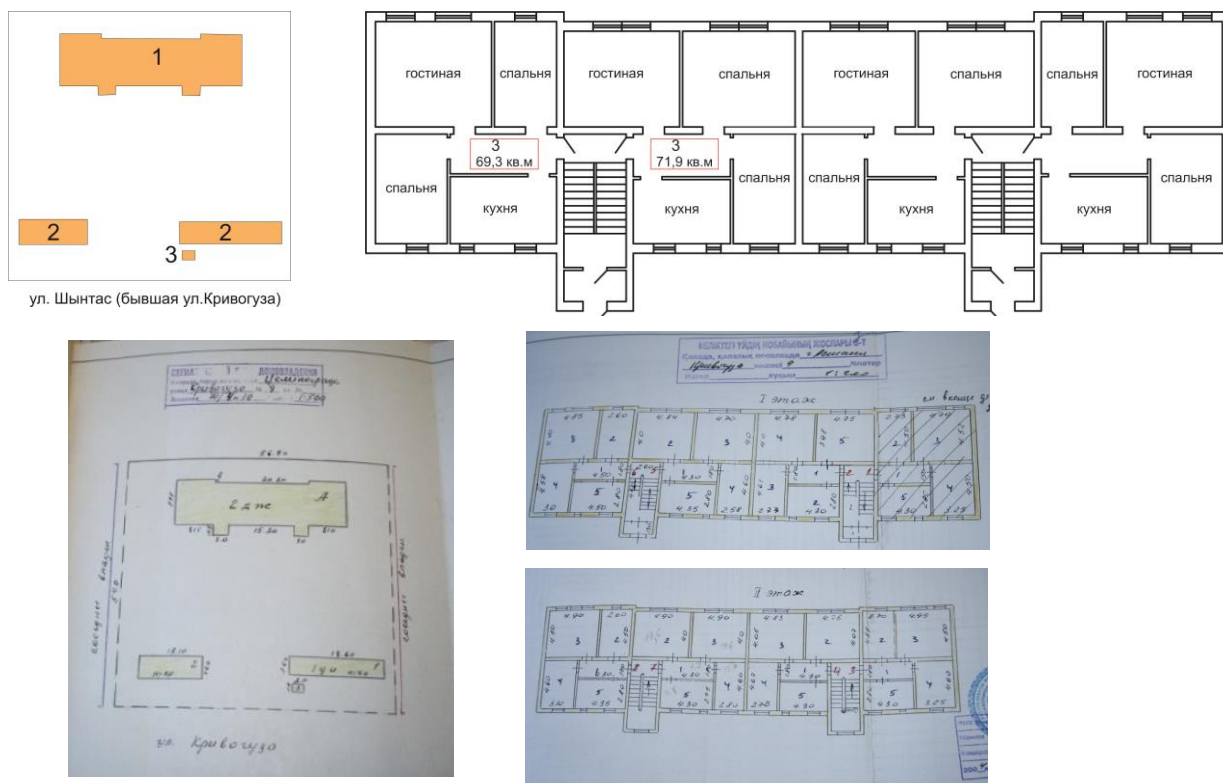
План участка и план 1 этажа жилого дома по ул. Шынтас 9.
